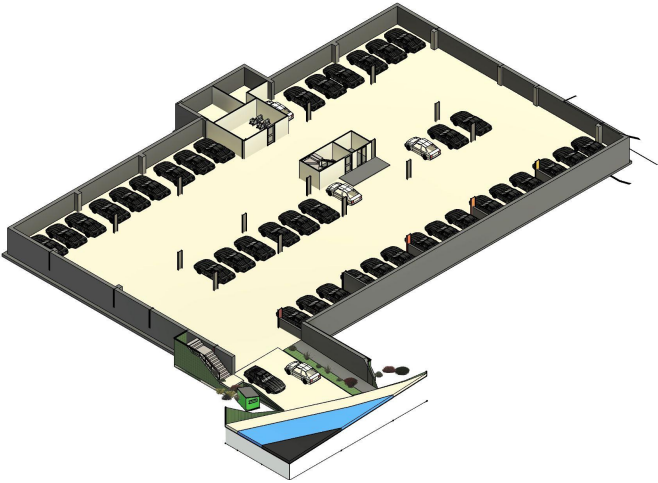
Vista 3D, planta de sótano. Fuente propia.
